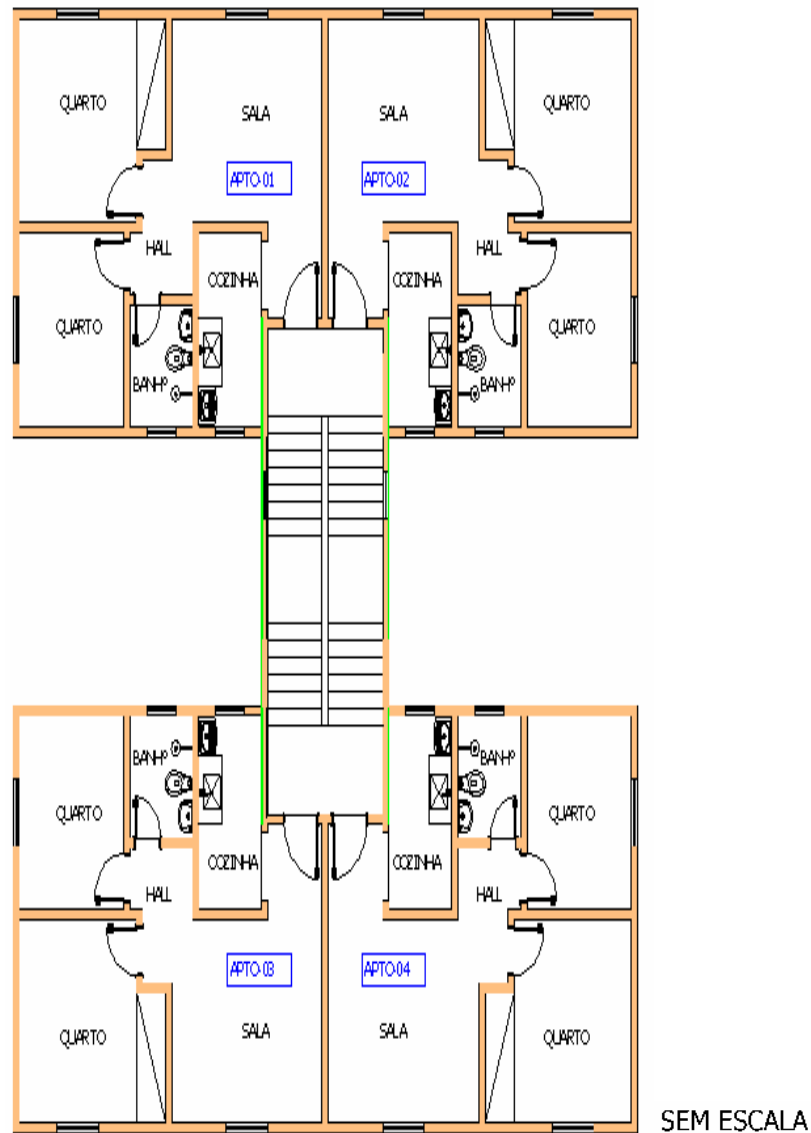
Planta Baixa lustrativa do pavimento tipo
